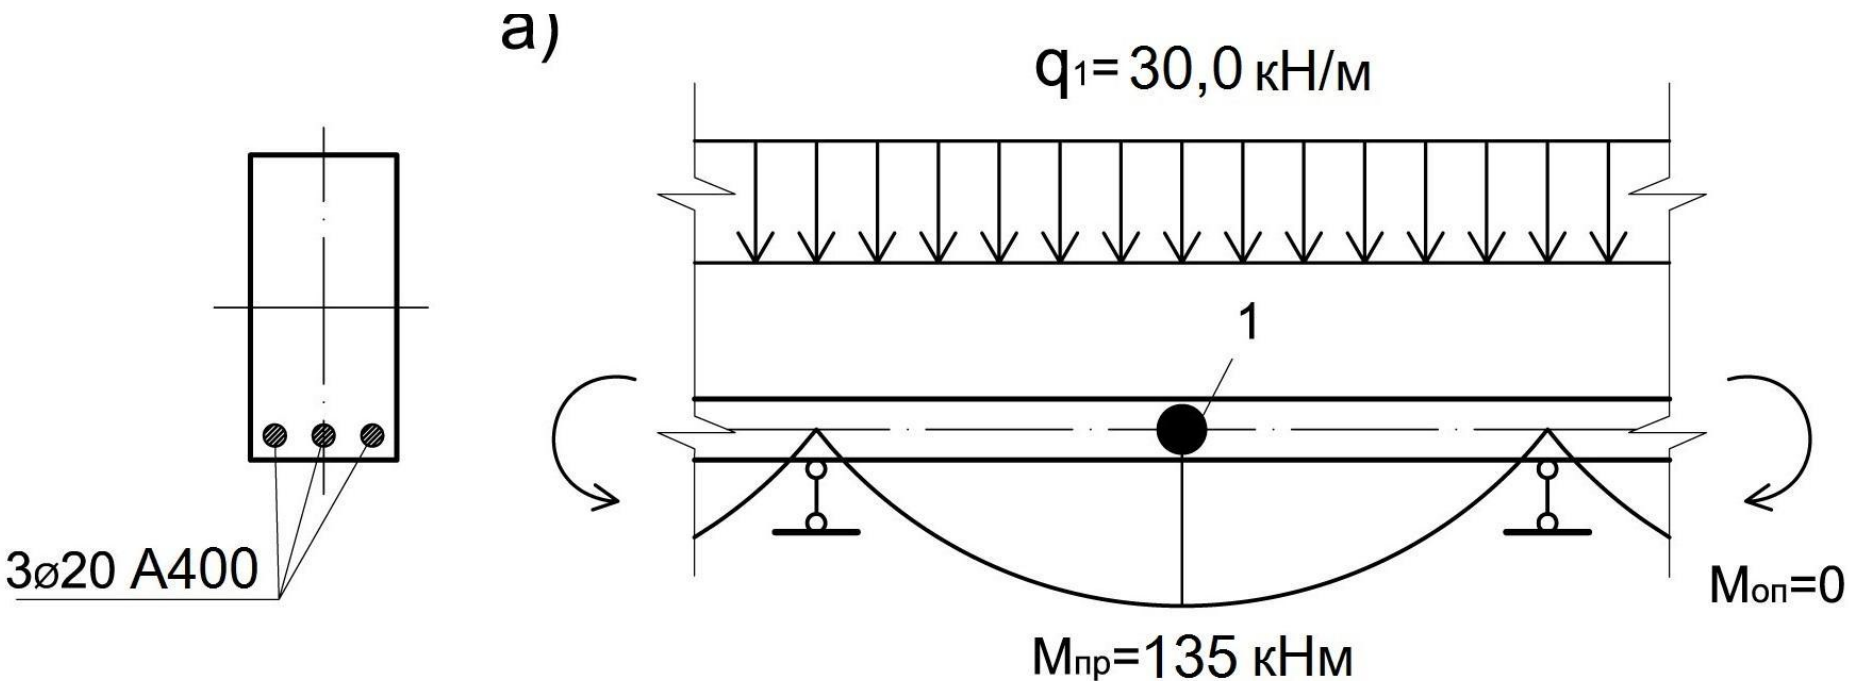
а. Статически допустимые поля усилий и соответствующее армирование. Армирование по разрезной схеме; 1 - пластические шарниры
